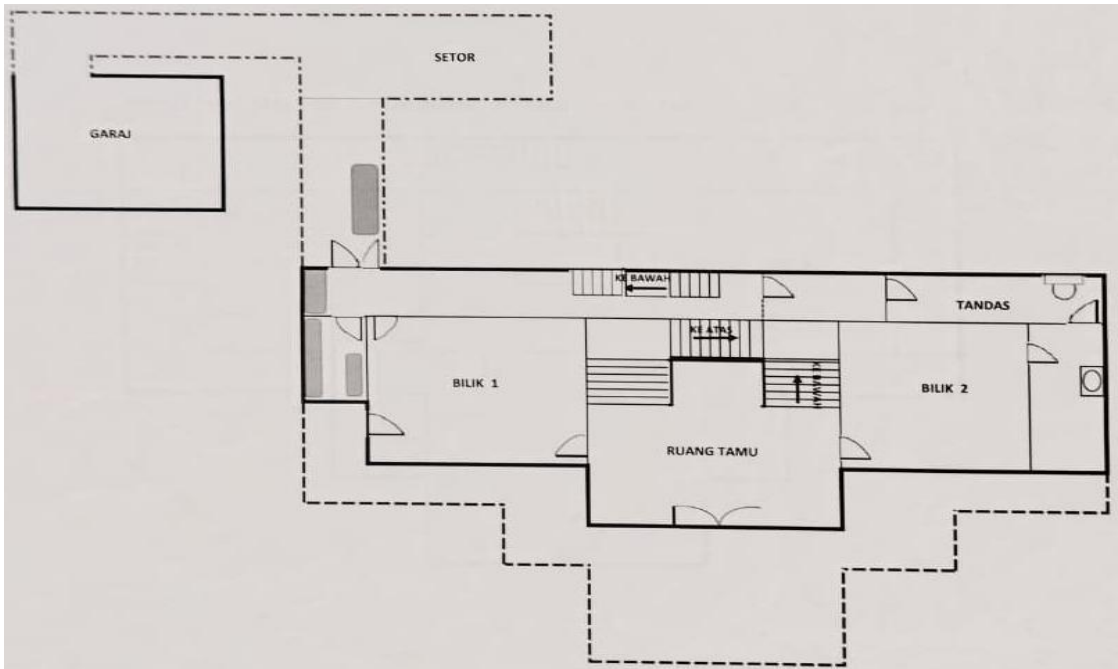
Pelan Lantai Aras Bawah Bangunan Sepoy Lines
